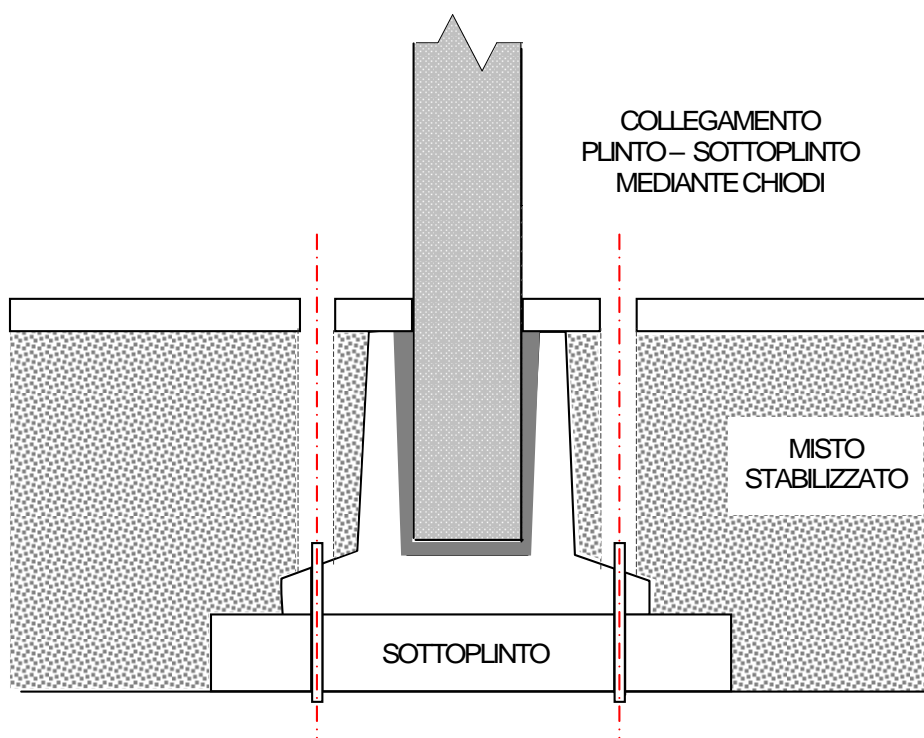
Intervento locale di collegamento plinto-sottoplinto mediante chiodature
